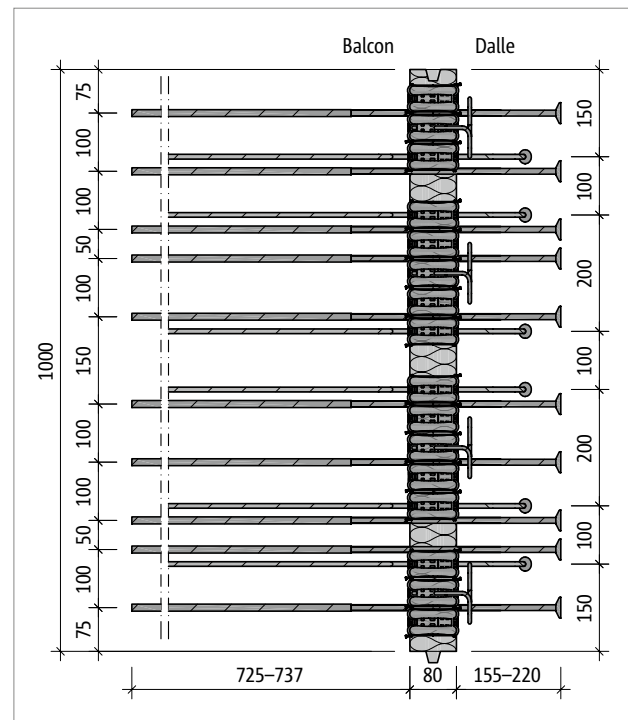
Schöck Isokorb® T type K-U-M4 : plan de base du produit
